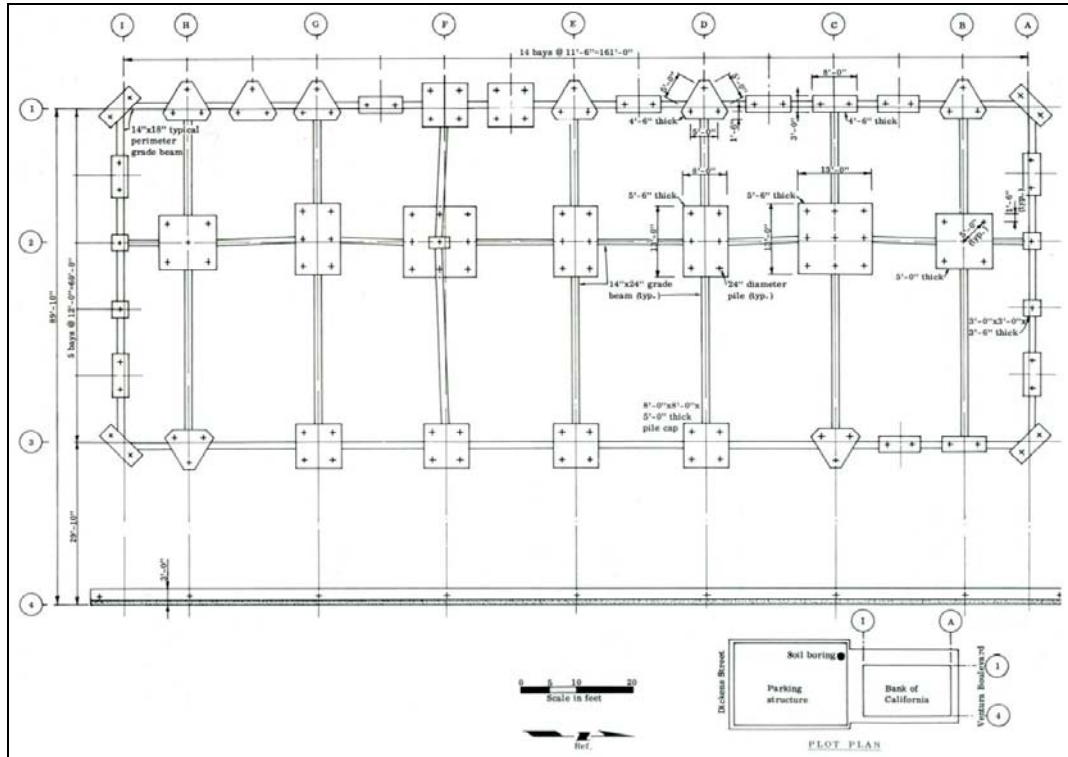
Planta de fundaciones edificio Bank of California. (NOAA, 1973)
